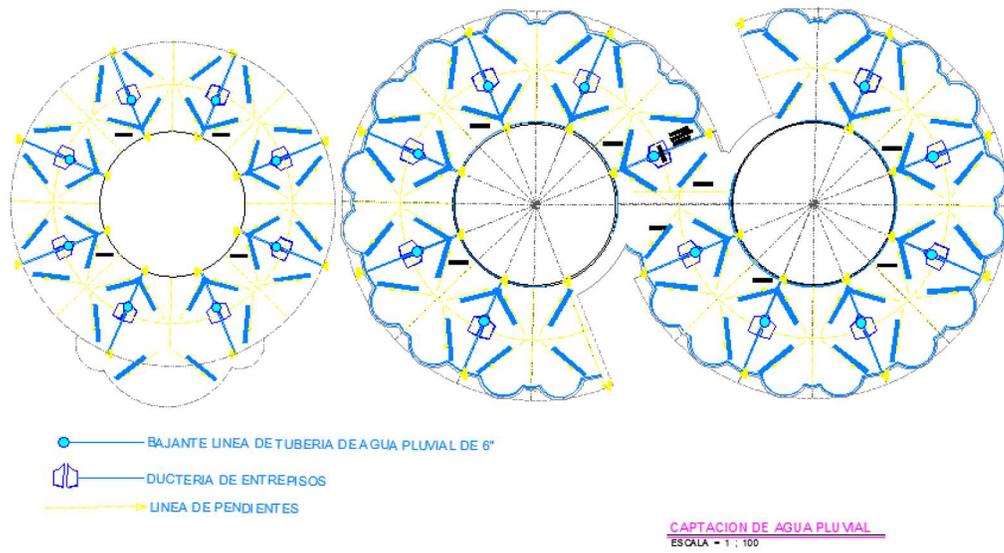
Plano de sistema de captación de agua pluvial en azoteas
